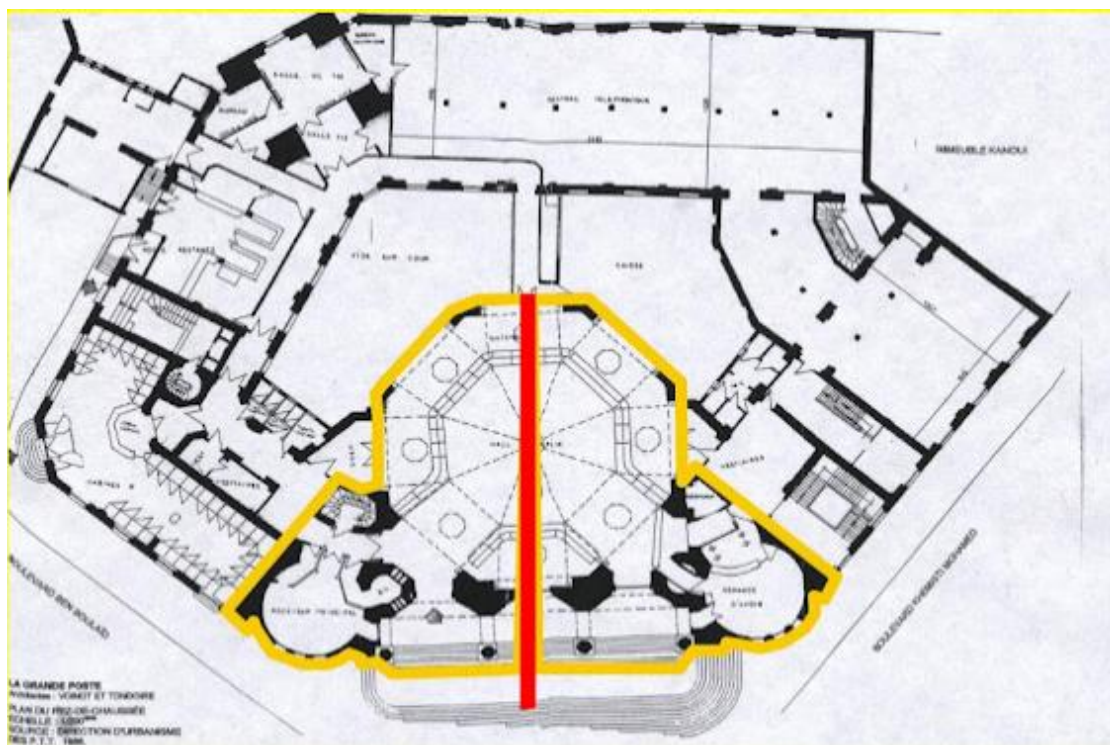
vue en plan de rez de chaussé de la Grande Poste
